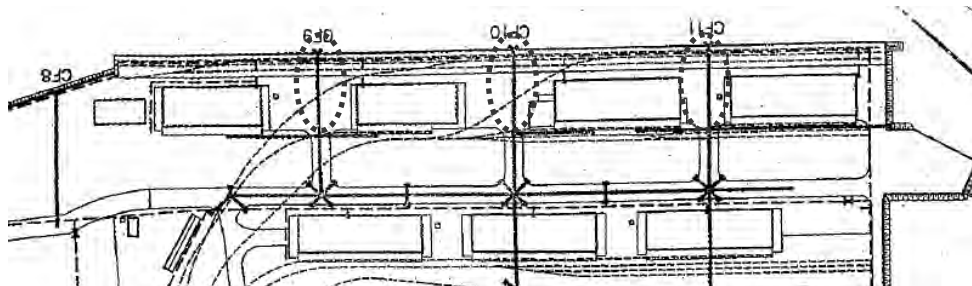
既存排水施設平面図及び排水管破損範囲
